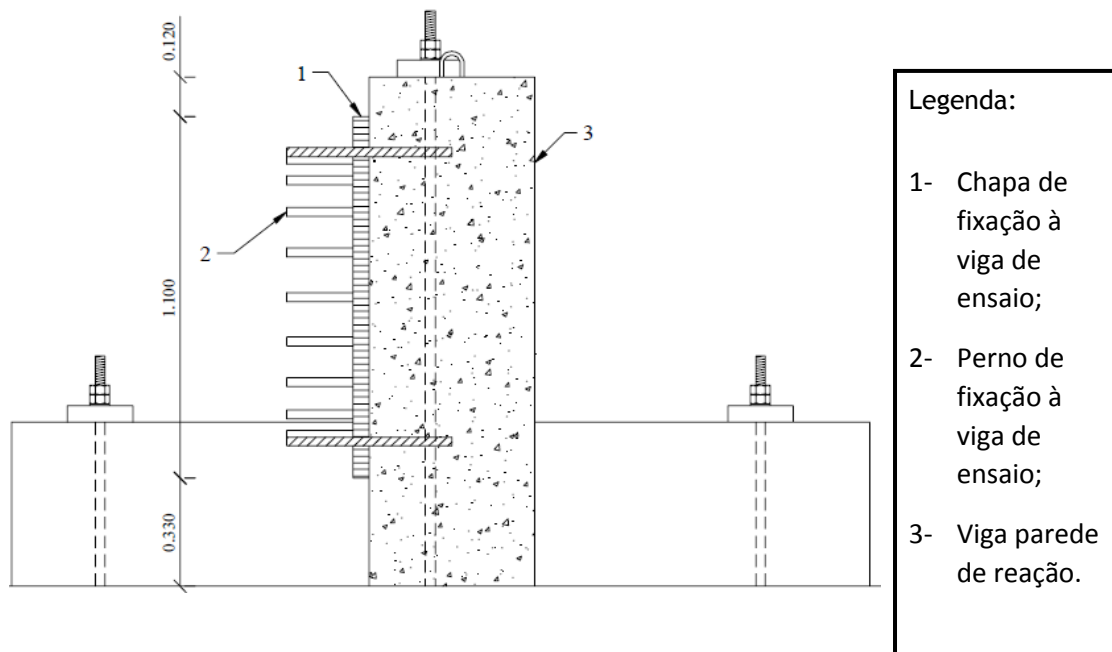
Corte longitudinal do dispositivo de encastramento [17]
